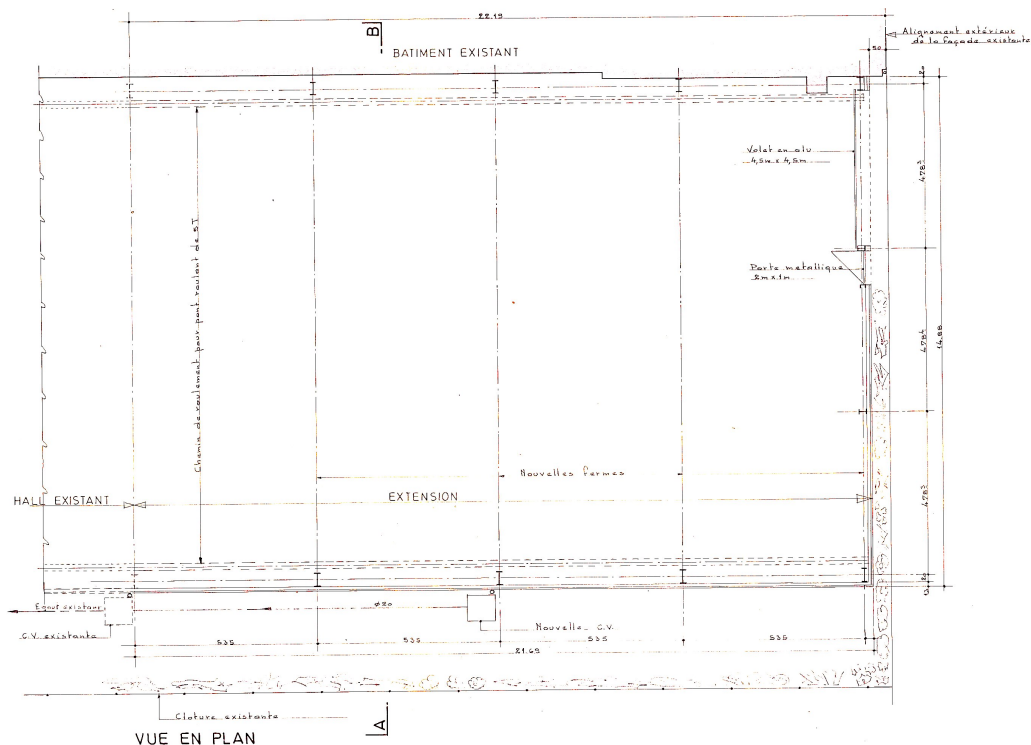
Plan de l'extension, cas n°1 (Source : Archives de Liège)
